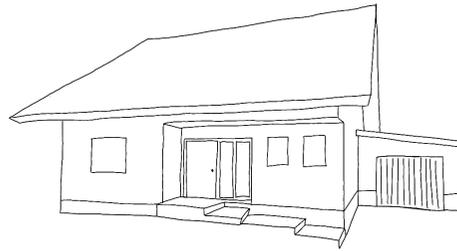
Einfamilienhausstruktur mit Schwarzplan
